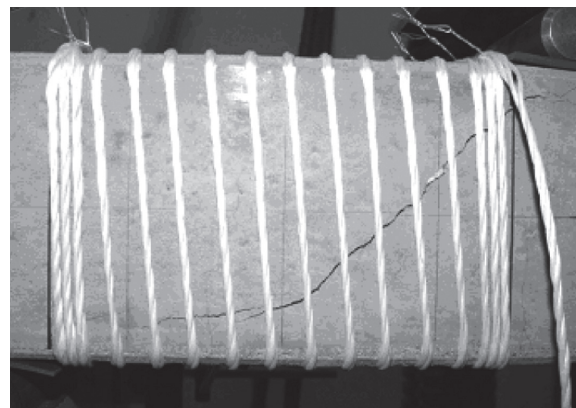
斜めひび割れ状況 (No.3)
